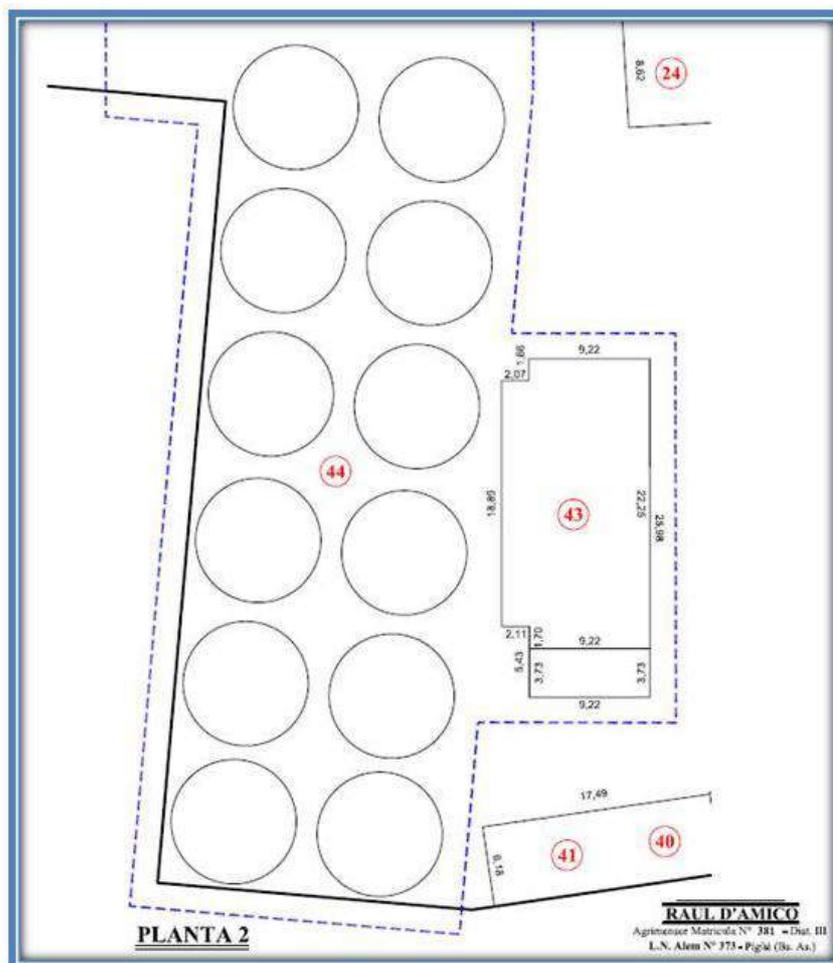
Planta de Silo 2 (Ref. n° 44) y Caseta de descarga (Ref. n° 43)
